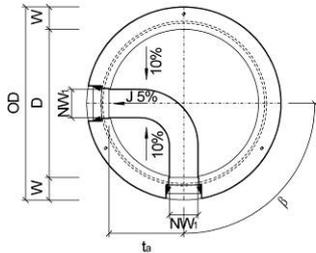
Grundriss CRENO Normschachtboden Typ 9
